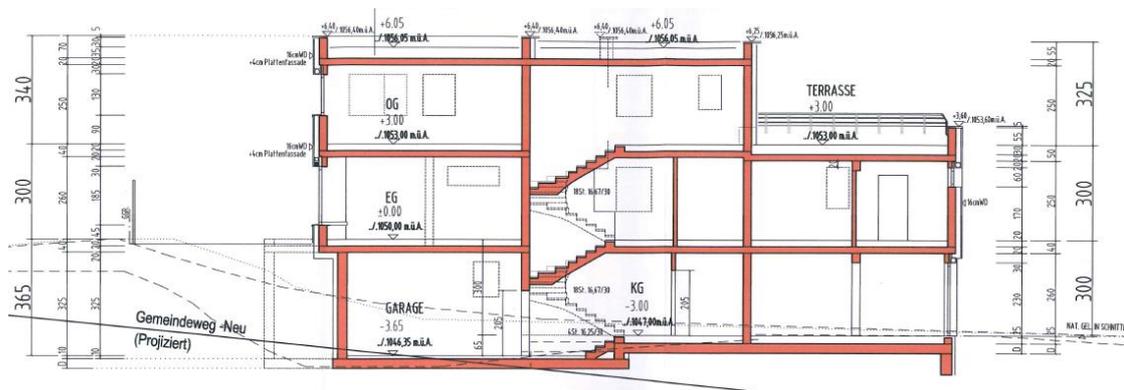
Schnitt A-A – geplantes Wohngebäude auf der neu vermessenen Gp. 305 laut Einreichplan seitens des Planungsbüros R&S Planbau (ohne Maßstab)
